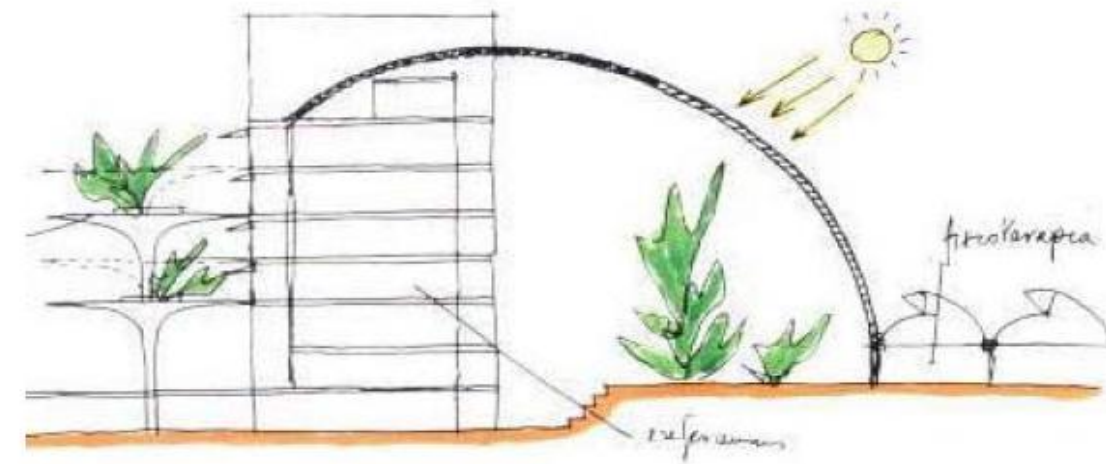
Croqui Cobertura metálica em arco para proteção da insolação - Hospital Sarah Kubitschek/Salvador
